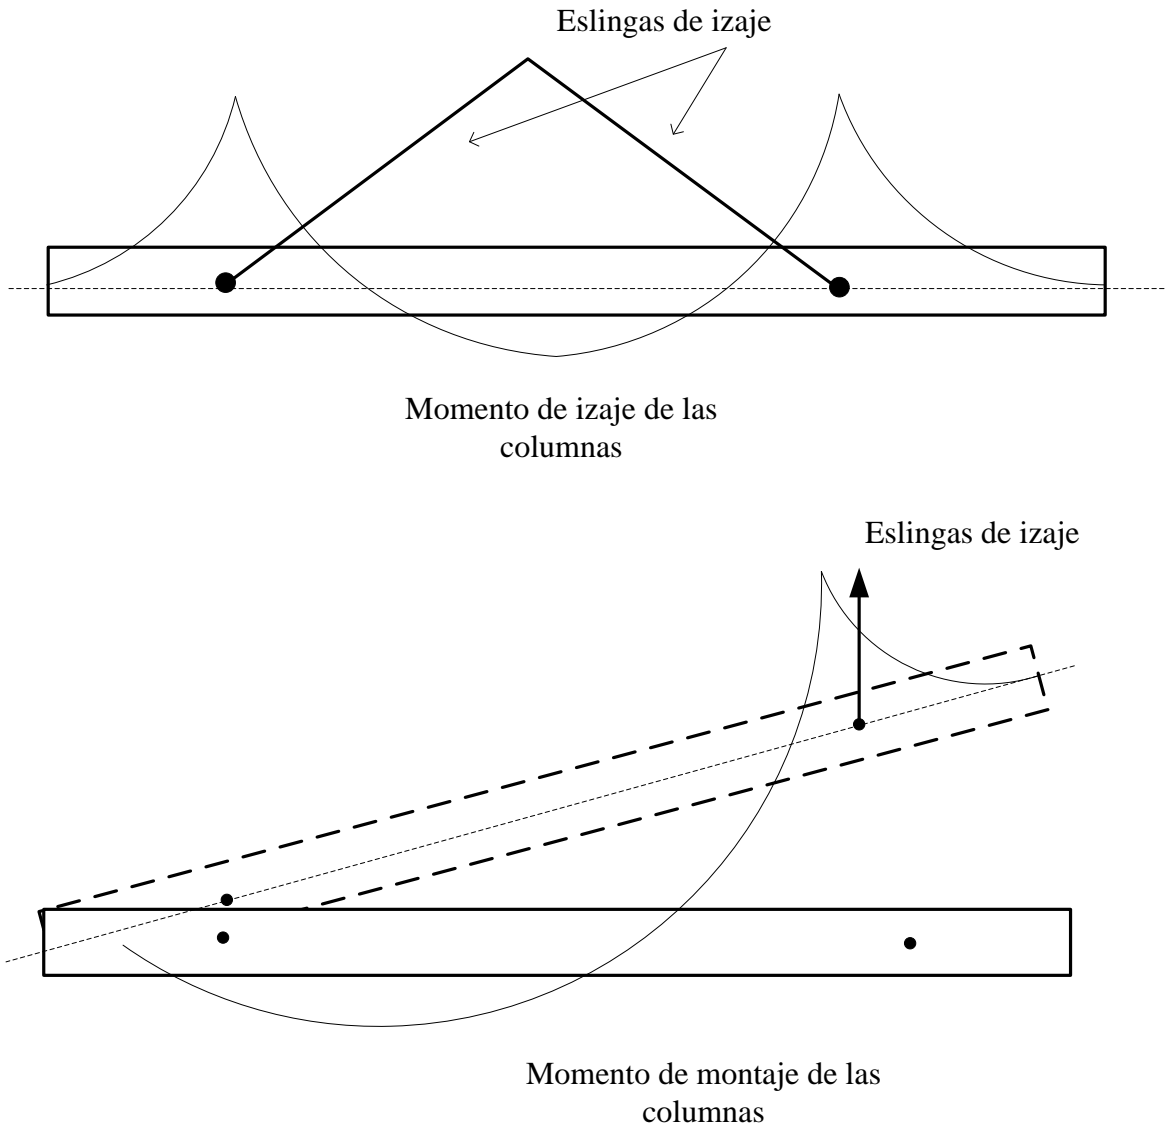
Esquema de despegue e izaje de las columnas prefabricadas
